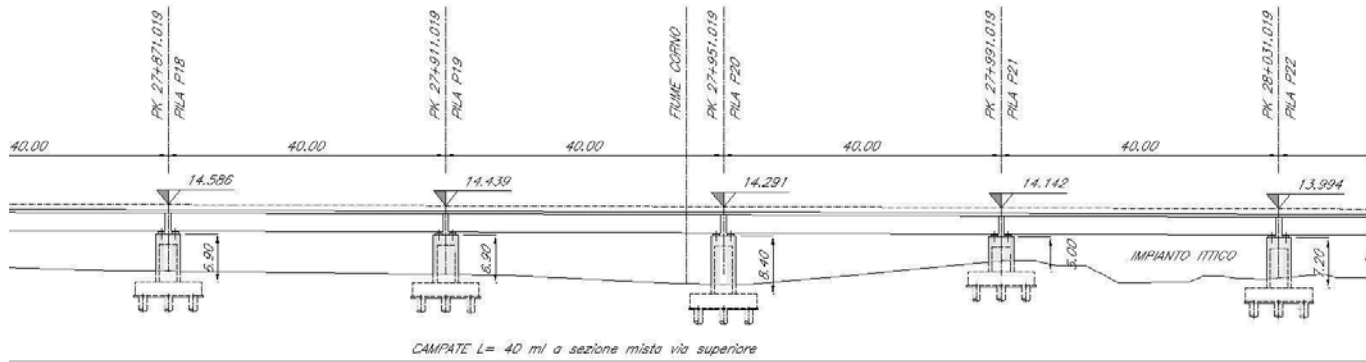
Prospetto dell'attraversamento del fiume Corno.
